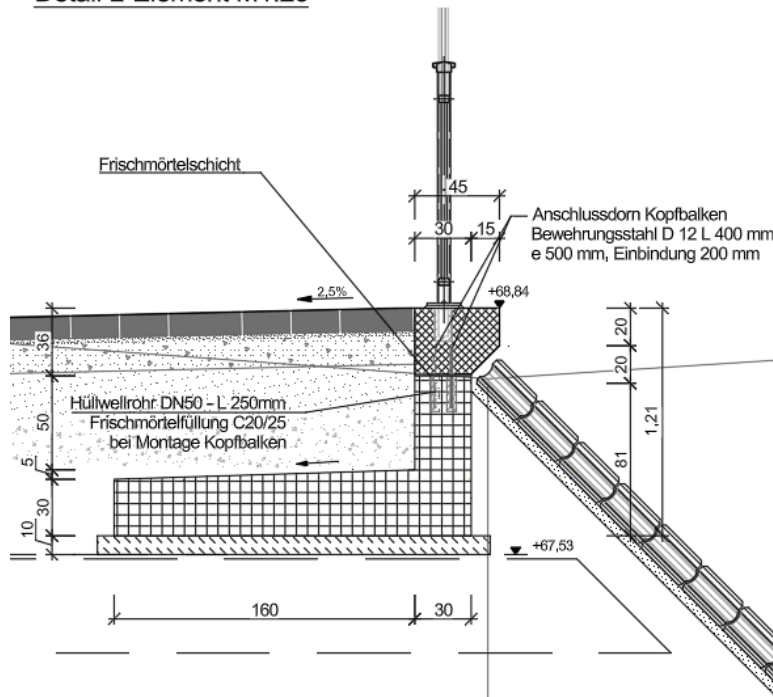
Oberer Böschungsabschluss auf Stahlbetonfertigteile L-Element
